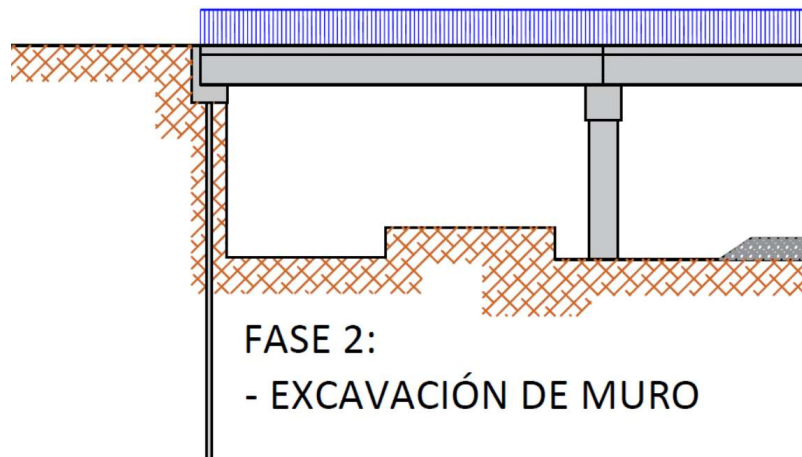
Fase 2 Excavación de muro. Fuente: propia.
